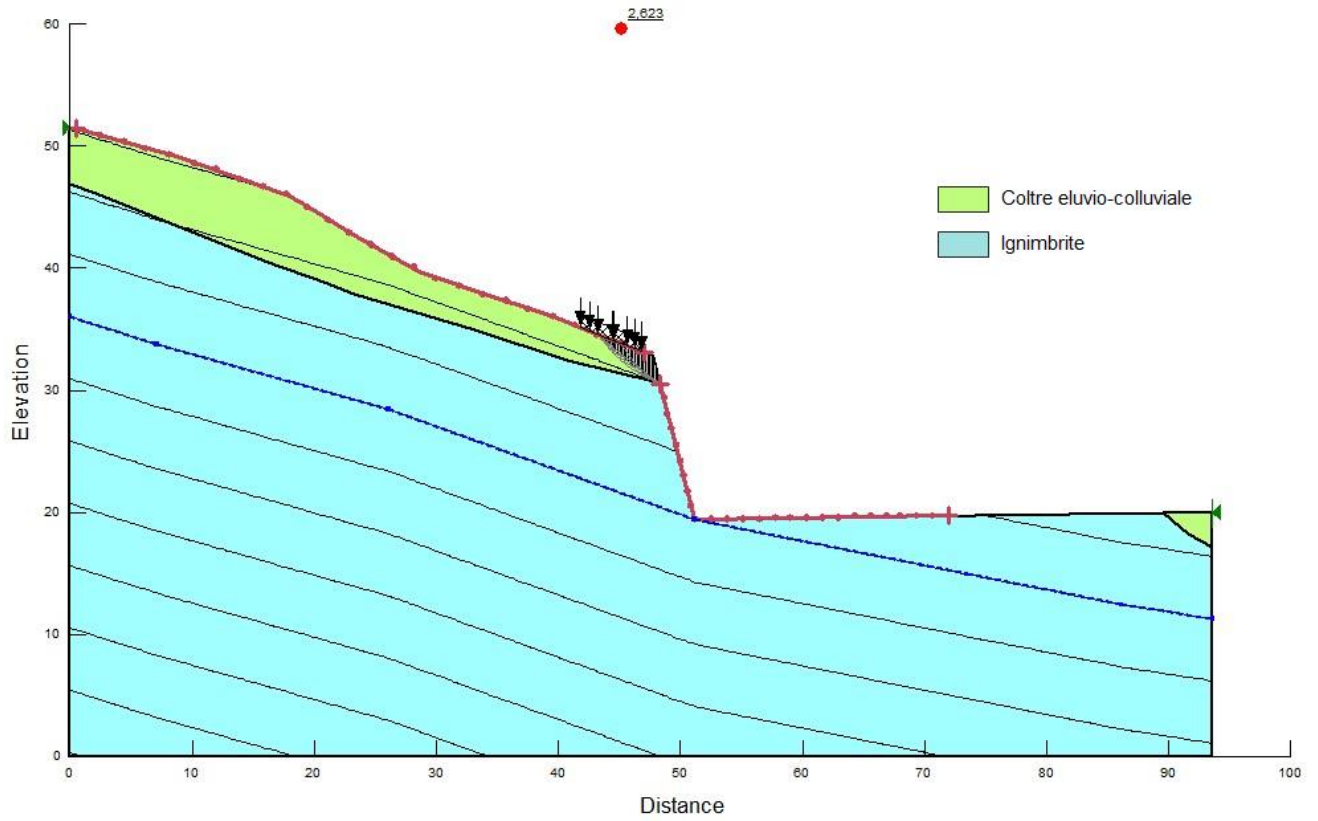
Analisi di stabilità locale (Galleria Giave – imbocco sud – condizioni statiche)
